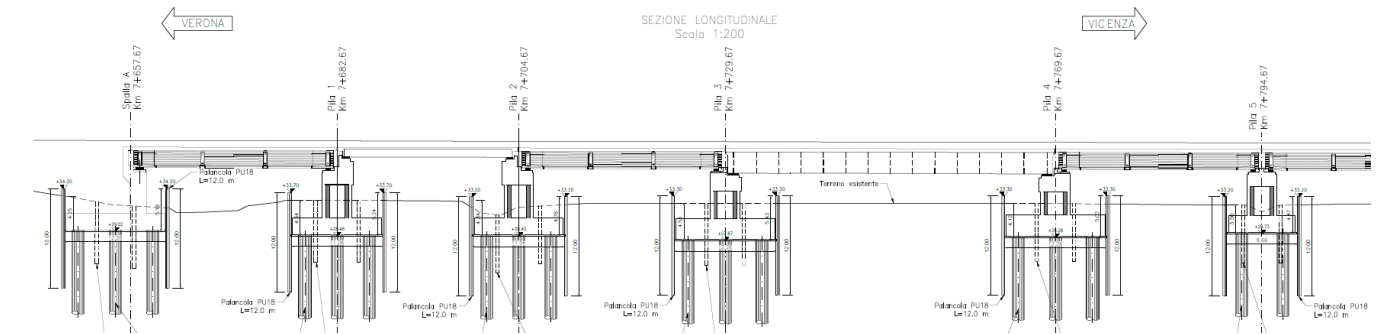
sezione longitudinale da spalla a a pila 5
